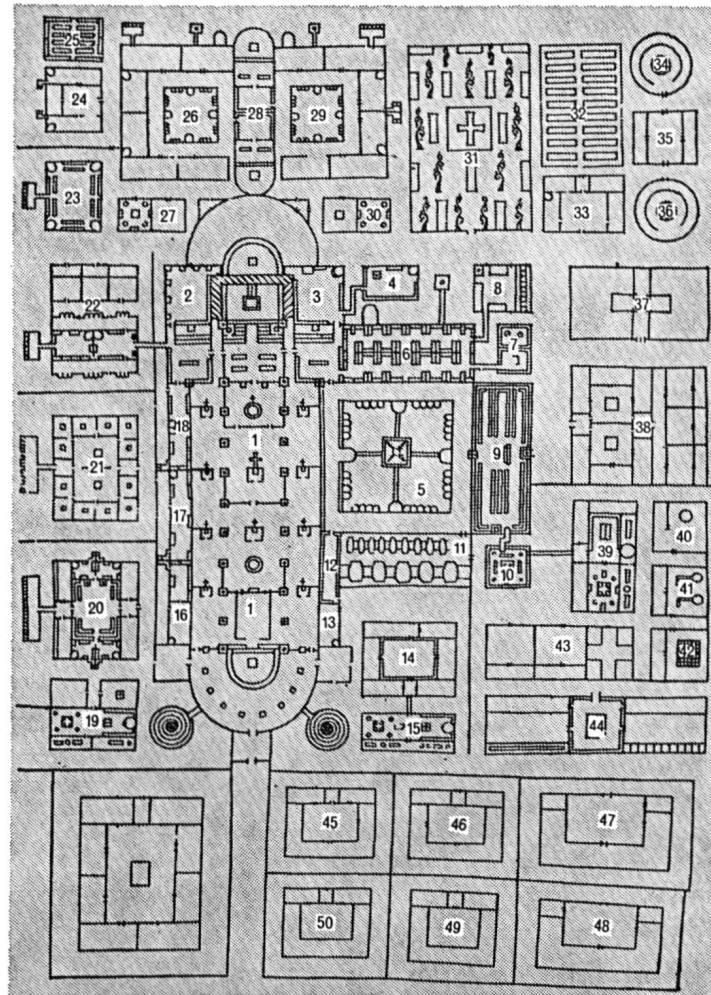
St. Galler Klosterplan. Umzeichnung mit Numerierung der Einzelbauten, nach Kunstdenkmäler Kt. St. Gallen, Bd. III. – 1 Kirche mit Türmen, 2 Schreibstube und Bibliothek, 3 Sakristeien, 4 Hostienbäckerei und Ölpresse, 5 Kreuzgang, 6 Warmraum und Dormitorium, 7 Dampf- und Kaltbad, 8 Abort, 9 Refektorium, 10 Küche, 11 Keller, 12 Sprechraum für die Besuche und die Fusswaschung, 13 Stube des Armenverwalters, 14 Pilgerherberge, 15 Brauerei und Bäckerei der Pilgerherberge, 16 Pförtnerwohnung, 17 Wohnung des Schulvorstehers, 18 Raum für durchreisende Brüder, 19 Brauerei und Bäckerei des Gästehauses, 20 Gästehaus, 21 äussere Schule, 22 Abtshaus, 23 Aderlasshaus, 24 Ärzthaus, 25 Kräutergärtlein, 26 Krankenhaus, 27 Küche und Bad des Krankenhauses und des Aderlasshauses, 28 Doppelkapelle für das Krankenhaus und für das Noviziat, 29 Noviziat, 30 Küche und Bad des Noviziats, 31 Friedhof und Obstgarten, 32 Gemüsegarten, 33 Gärtnerwohnung, 34 Gänsestall, 35 Wärterwohnung, 36 Hühnerstall, 37 Kornscheune, 38 Werkstätten, 39 Küche und Brauerei des Konvents, 40 Mühle, 41 Stampfe, 42 Darre, 43 Kornhaus und Küferei, 44 Stier- und Pferdestall, 45 Schafstall, 46 Ziegenstall, 47 Kuhstall, 48 Gestüt, 49 Schweinestall, 50 Gesindehaus.
